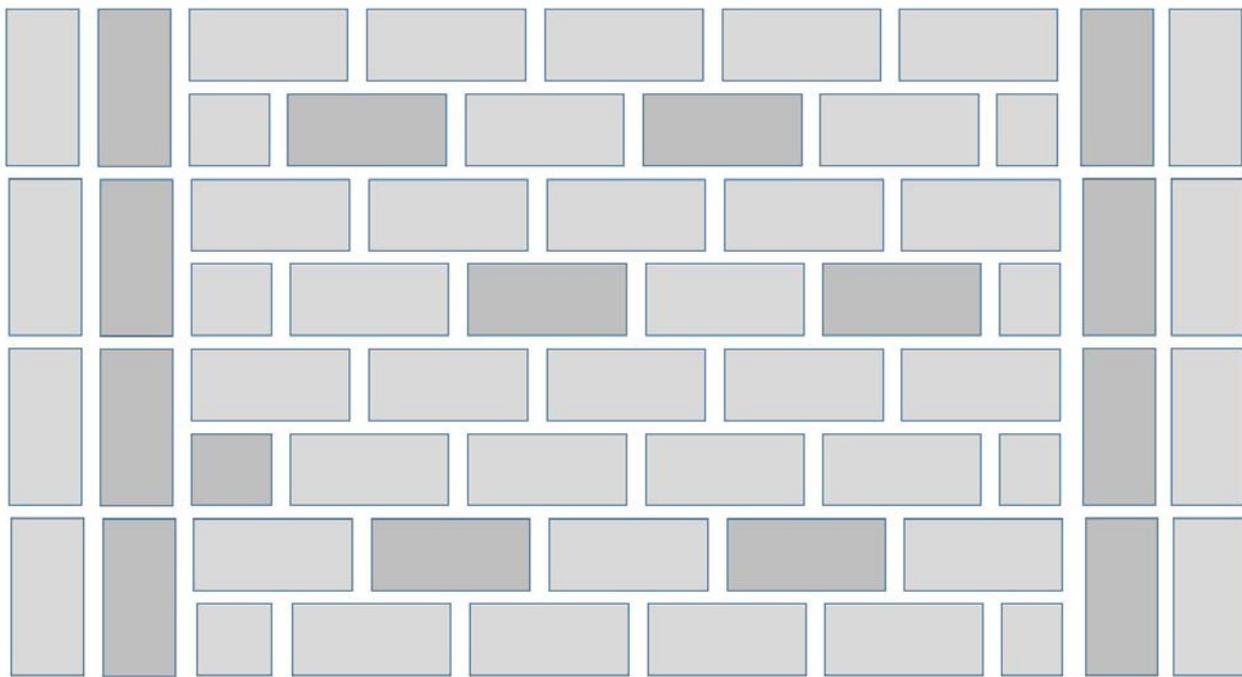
Exemples d'appareillage des plaquettes (largeur de joint 12 mm)
